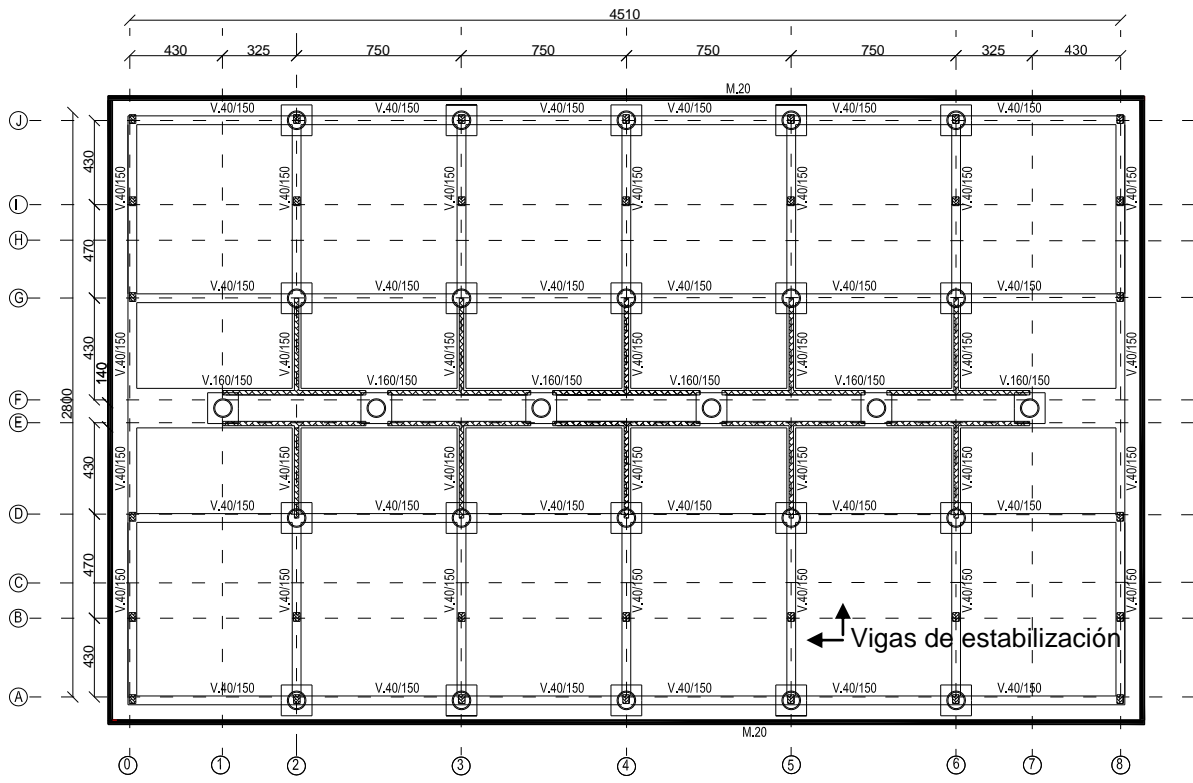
Planta nivel de aislación con vigas de conexión.
